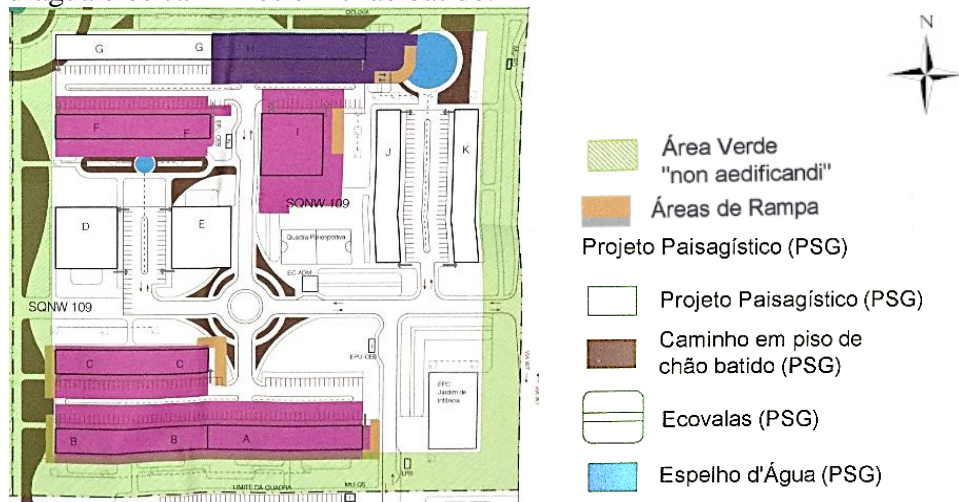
Planta do projeto paisagístico da SQNW 109 (NCA, 2011).
